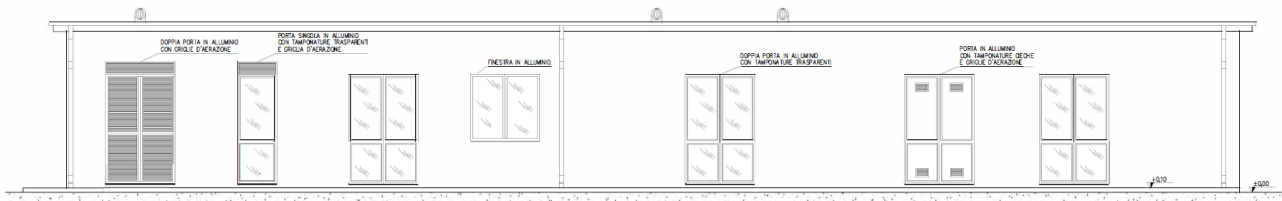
Architettonico fabbricato Cabina utente 150/30 kV – Prospetto
